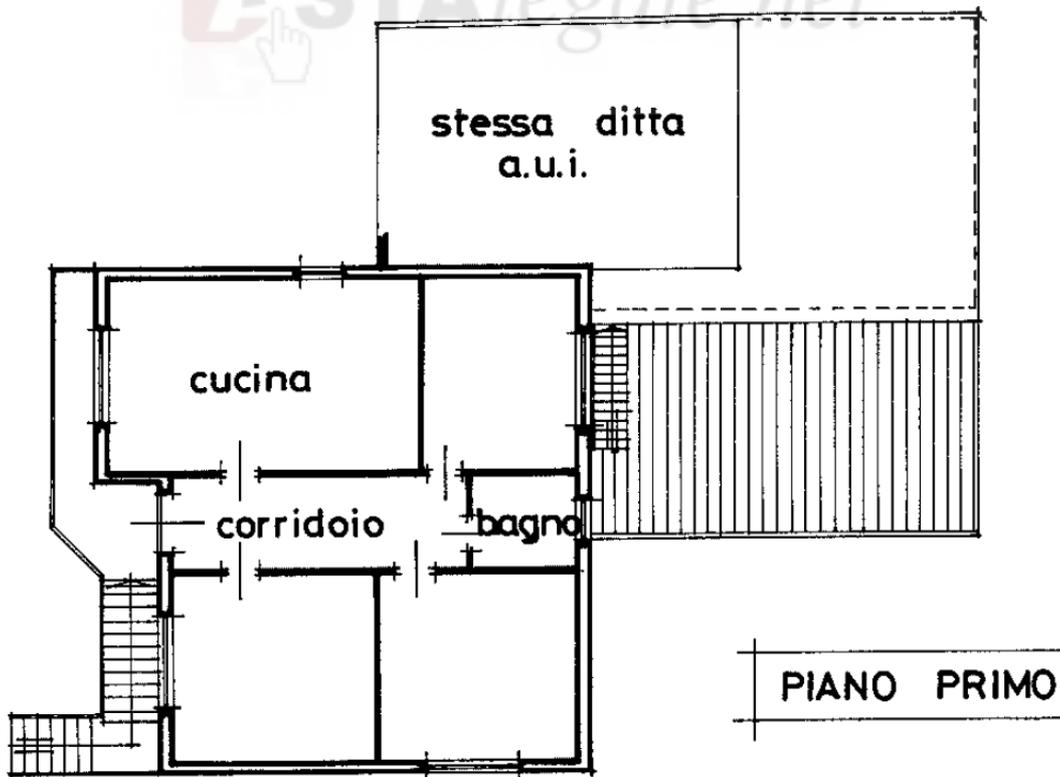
Estratto della planimetria catastale – sub. 4, p.p.
